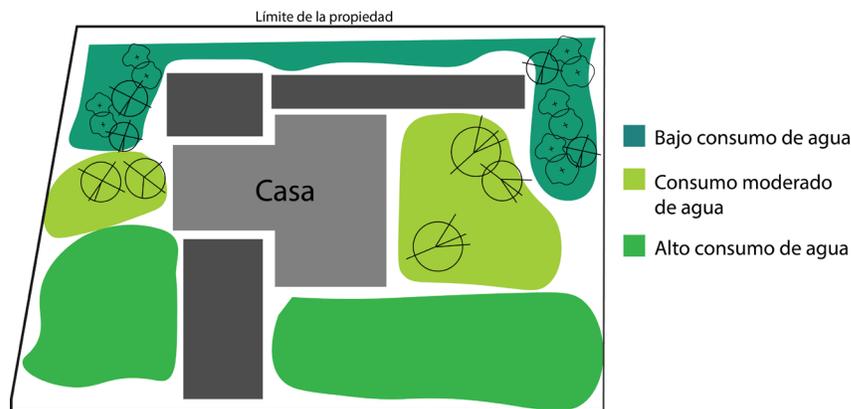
Ejemplo de diferentes Hidrozonas en planta
